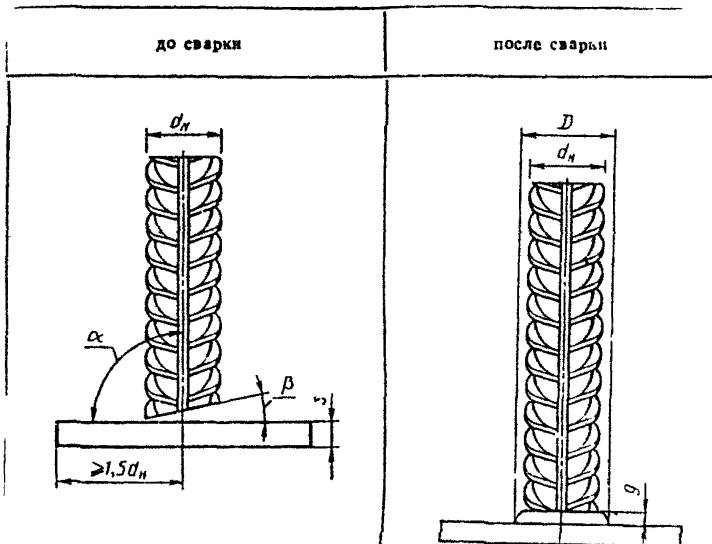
Конструкция таврового соединения, выполняемого сваркой под флюсом без дополнительного присадочного материала (типа Т1-Мф и Т2-Рф)
